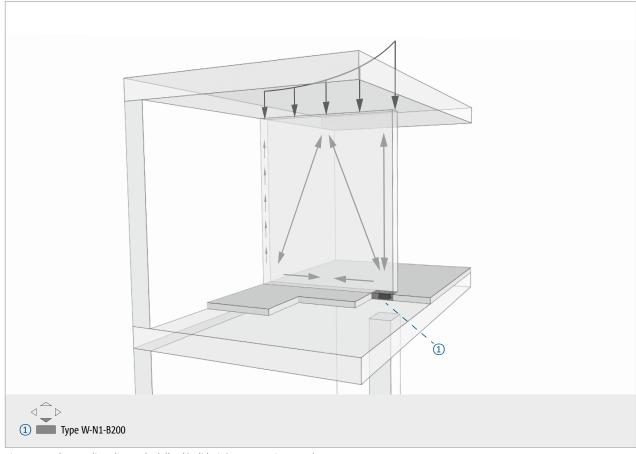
Mur de cage d'escalier sur la dalle, désolidarisé, avec appui ponctuel
